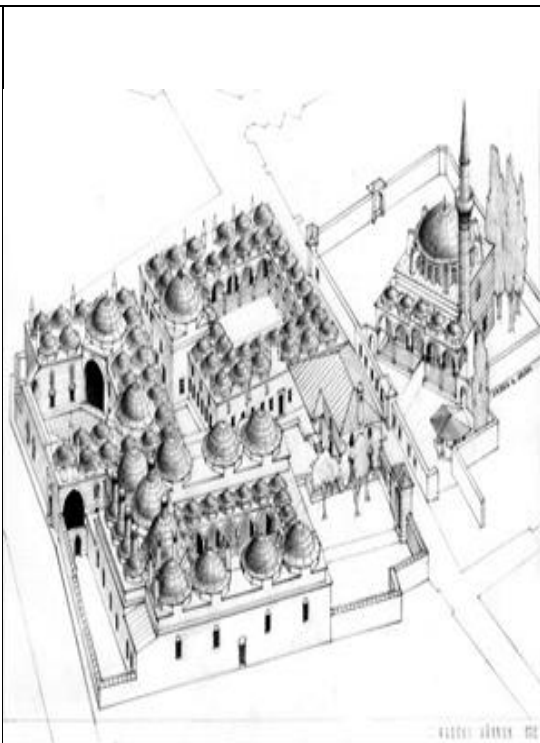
مسقط أفقى لكلية شمسي باشا
